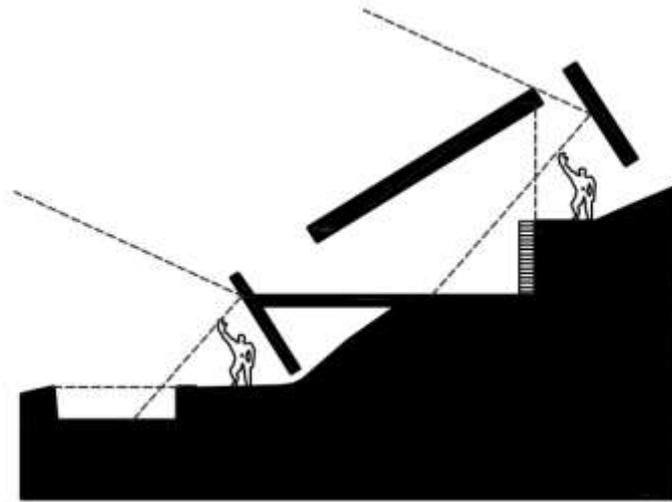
Diagramme de l'auteur, fond de coupe : coupe transversale dans le salon en double hauteur
